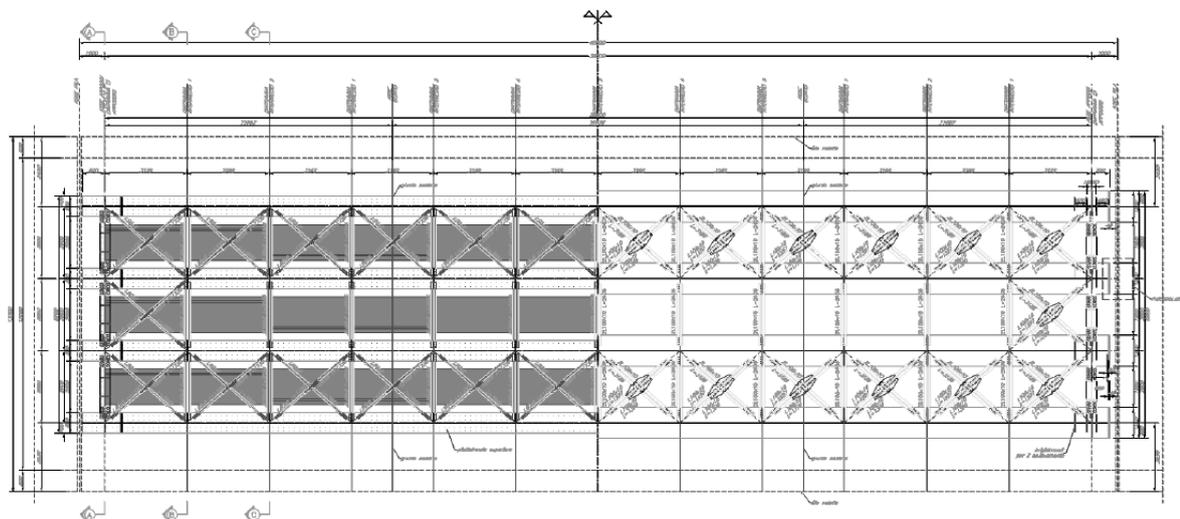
Pianta impalcato tipo – estratto dalla Relazione di calcolo del Progetto di Gara
